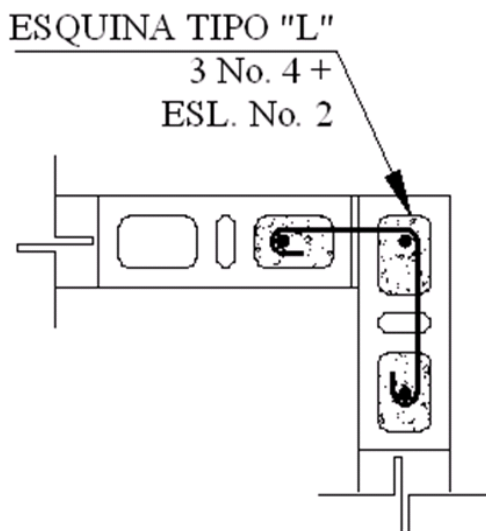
Refuerzo vertical en extremo de muro viviendas de dos niveles
